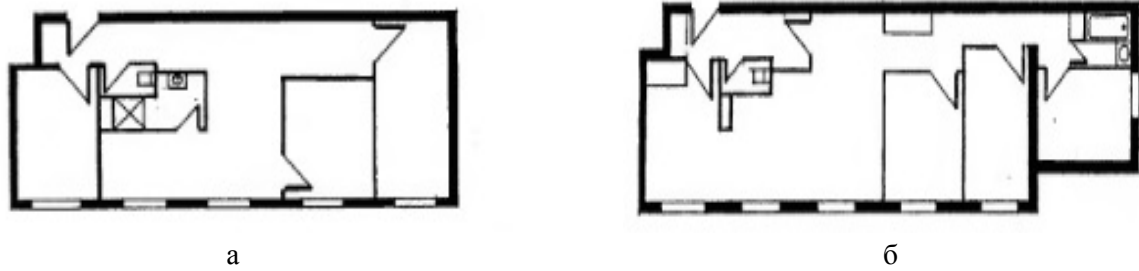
(а, б) План реконструкції квартири в районі Сент Жозеф, м.Нант (Франція)
